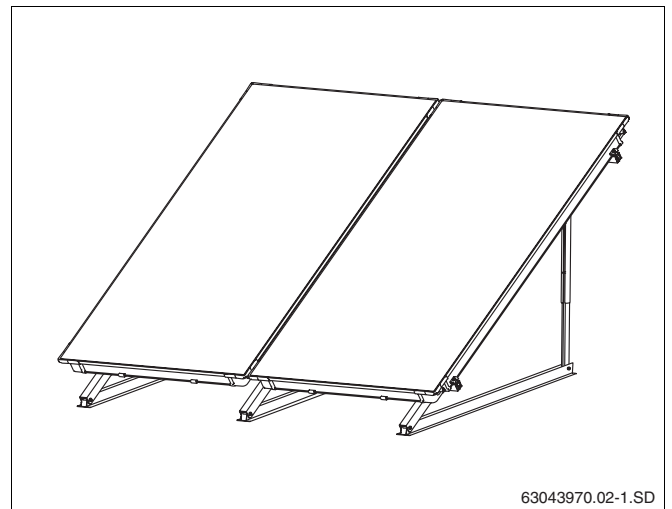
Gesamtansicht Kollektorpaar, Flachdachmontage
